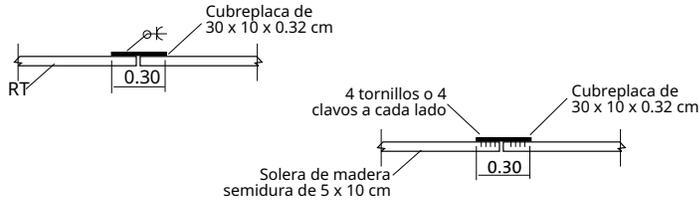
Detalle típico de la unión para garantizar continuidad de la solera
